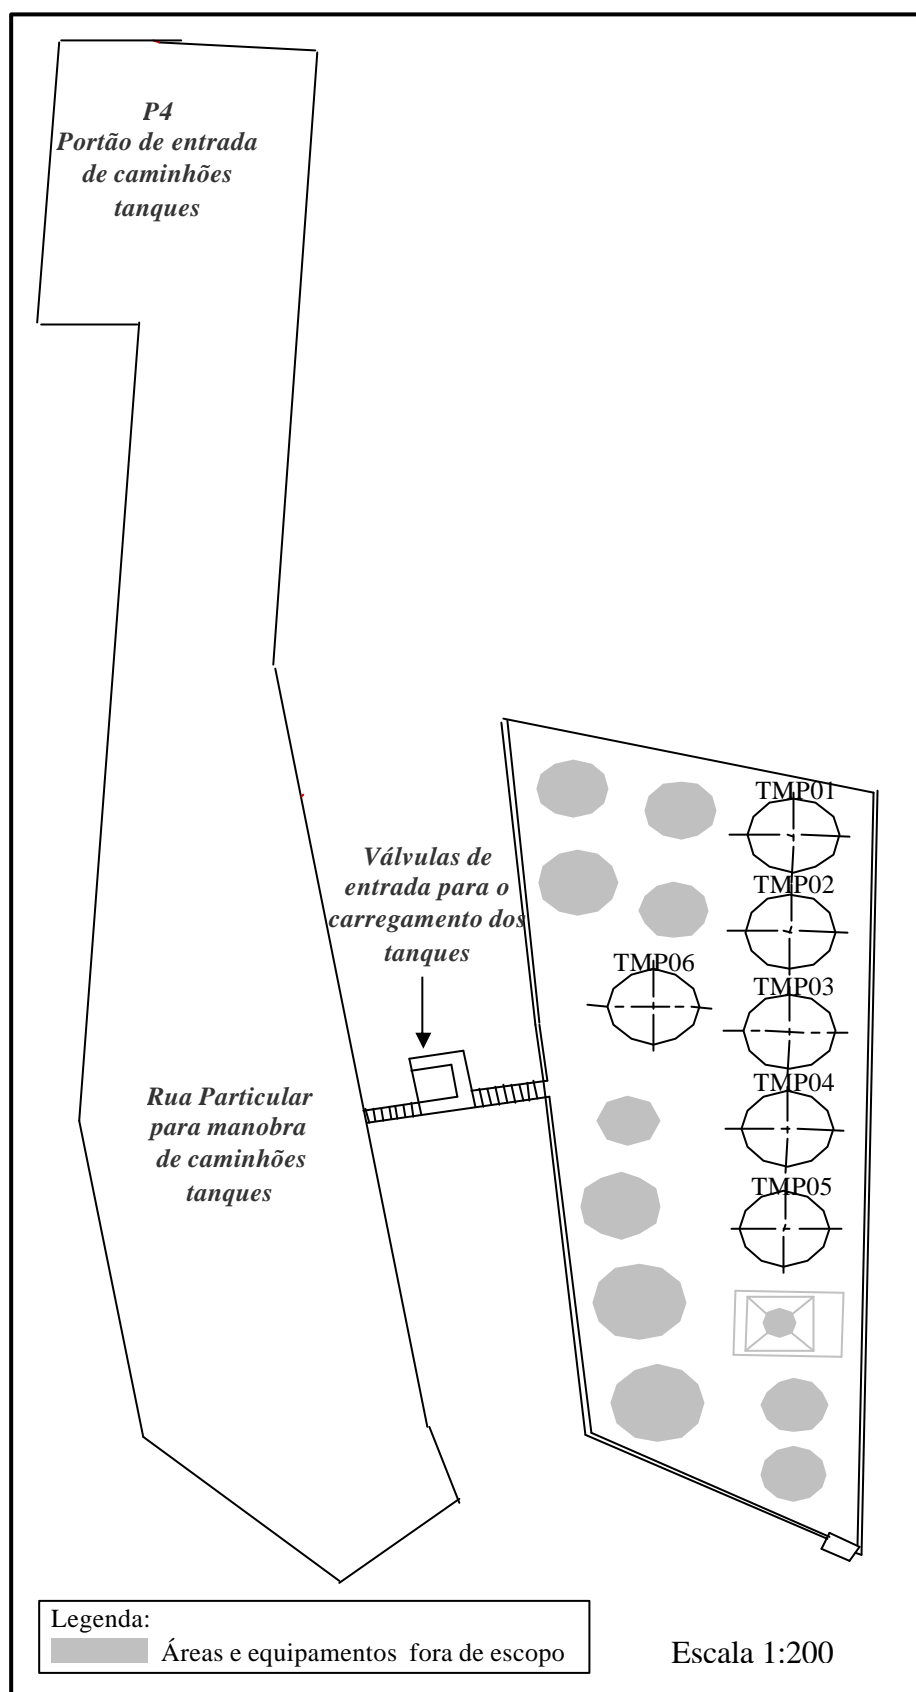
Layout atual da área de TANQUES. Elaborado pelo autor.
